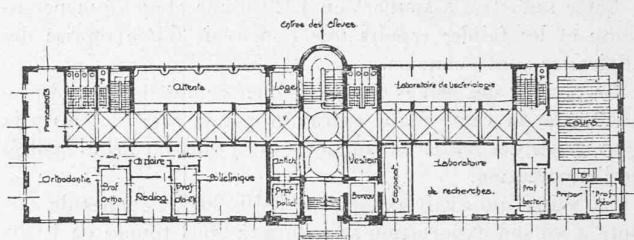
Plan du rez-de-chaussée. — 1 : 800.
